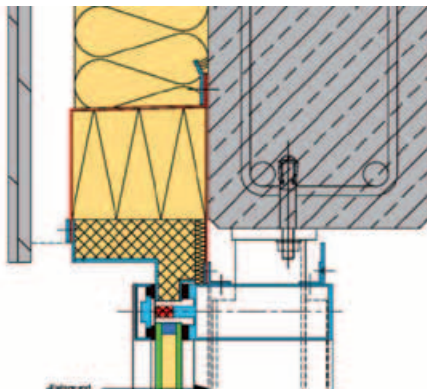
Oberer Anschluss einer Pfosten-/Riegelkonstruktion mit durch zusätzlichen Folienstreifen eingeschlossener Wärmedämmung.
